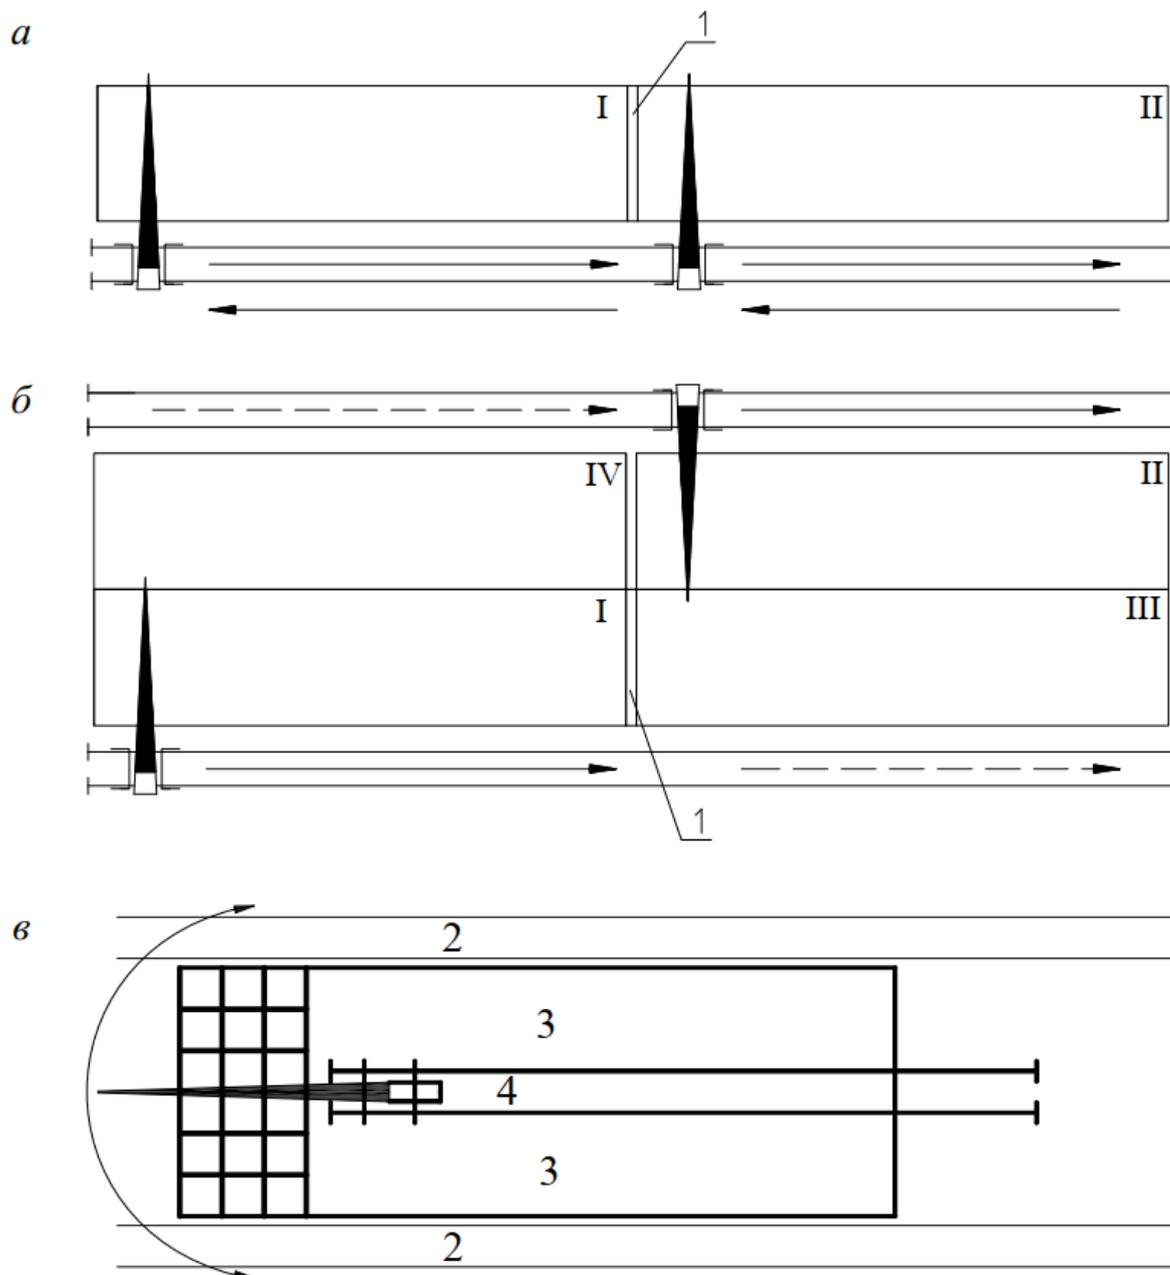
Схемы расположения башенного крана: а – с одной стороны здания; б – с двух сторон здания; в – в пятне застройки; 1 – температурно-осадочный шов; 2 – транспортные зоны; 3 – зоны складирования; 4 – подкрановые пути или зона движения башенного крана; I–IV – номера захваток
